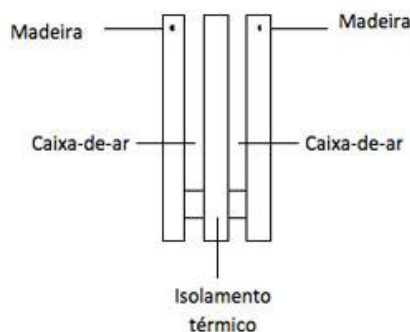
Sistema construtivo de paredes de madeira (BERCI, 2010)
